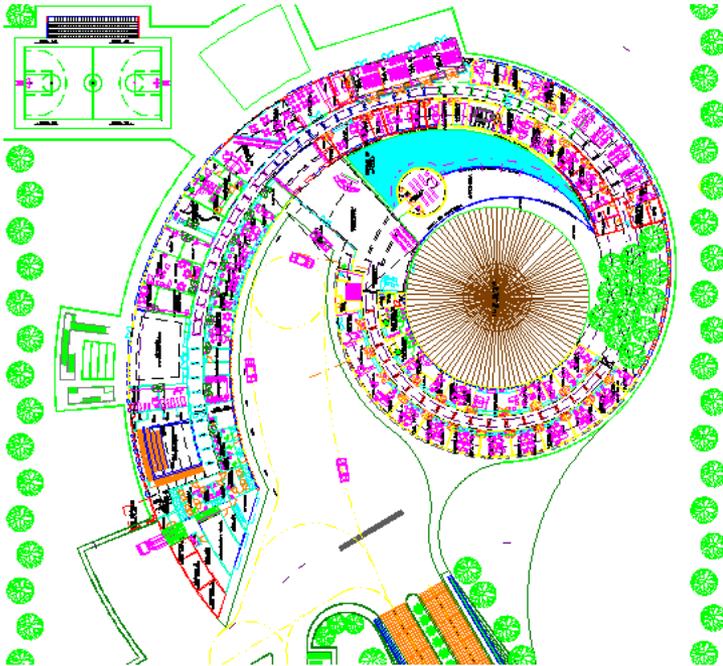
Planta arquitectónica edificio Crit Teletón Cancún
